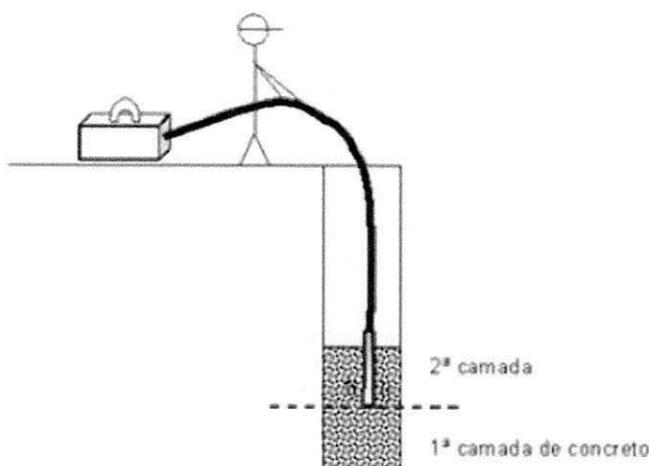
Uso de vibrador de agulha para adensamento de concreto em pilar.
